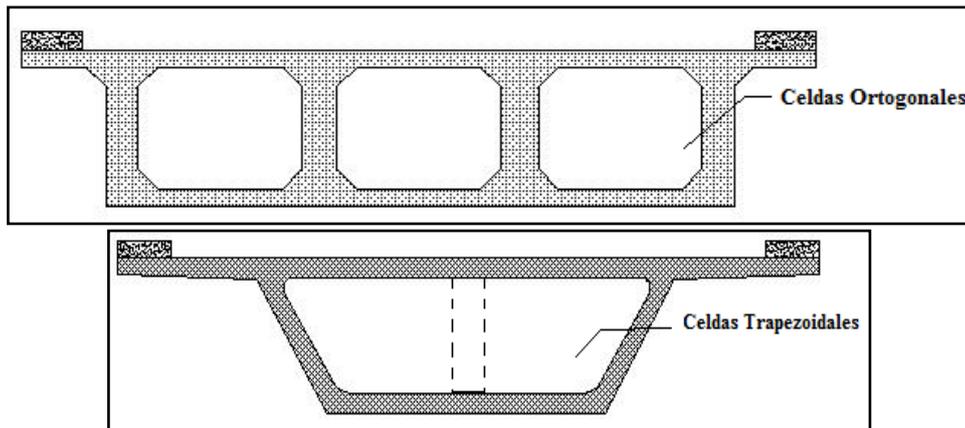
Vigas cajón Rectangulares y Trapezoidales.
